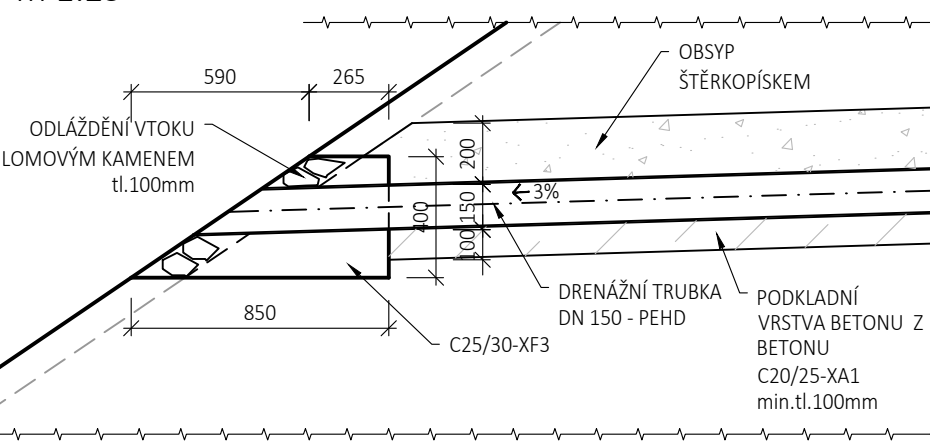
DETAIL H - PROSTUP DRENÁŽE KŘÍDLEM S POKRAČOVÁNÍM K VÝUŠTĚNÍ NA TERÉN
